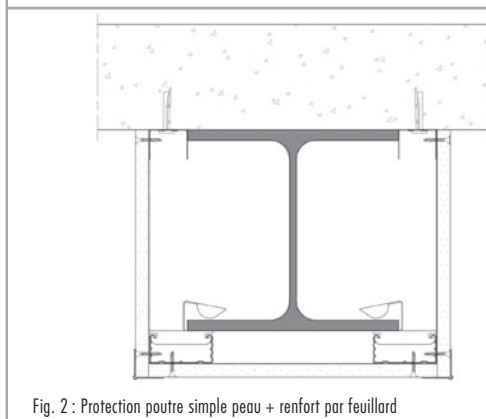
Protection poutre simple peau + renfort par feuillard
